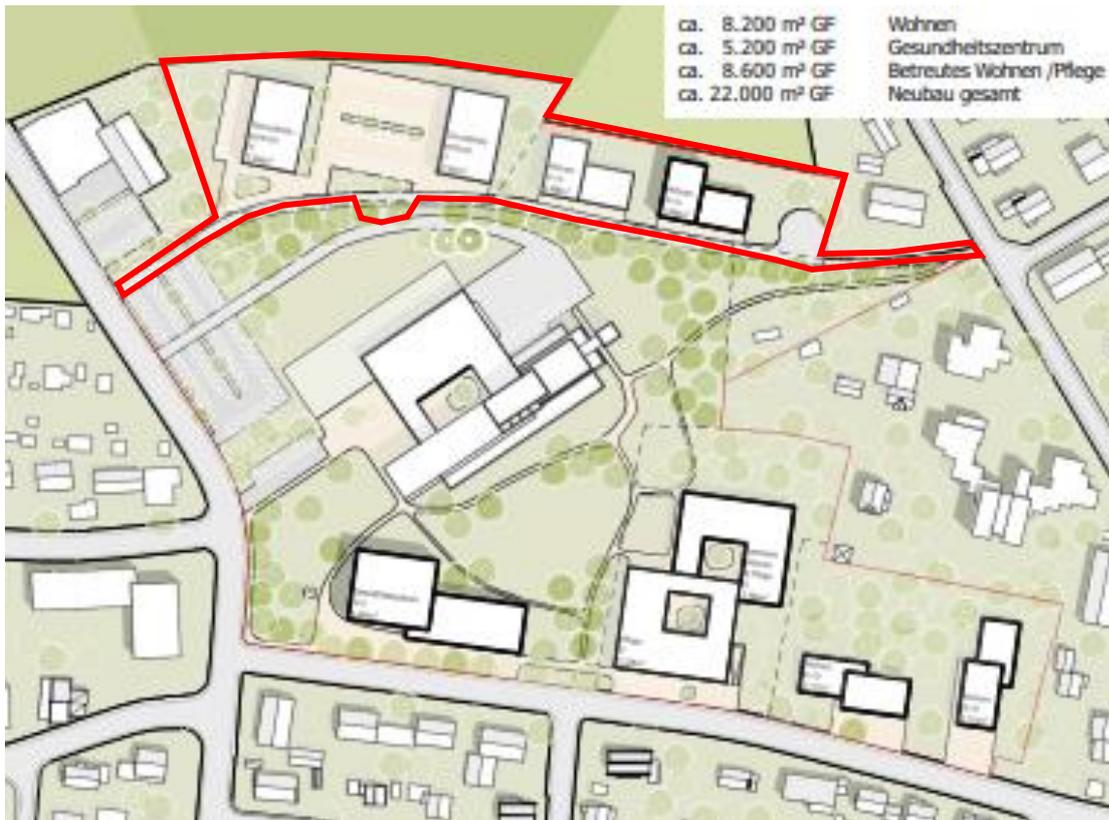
Darstellung der Eingriffsflächen (rot umrandete Fläche)
